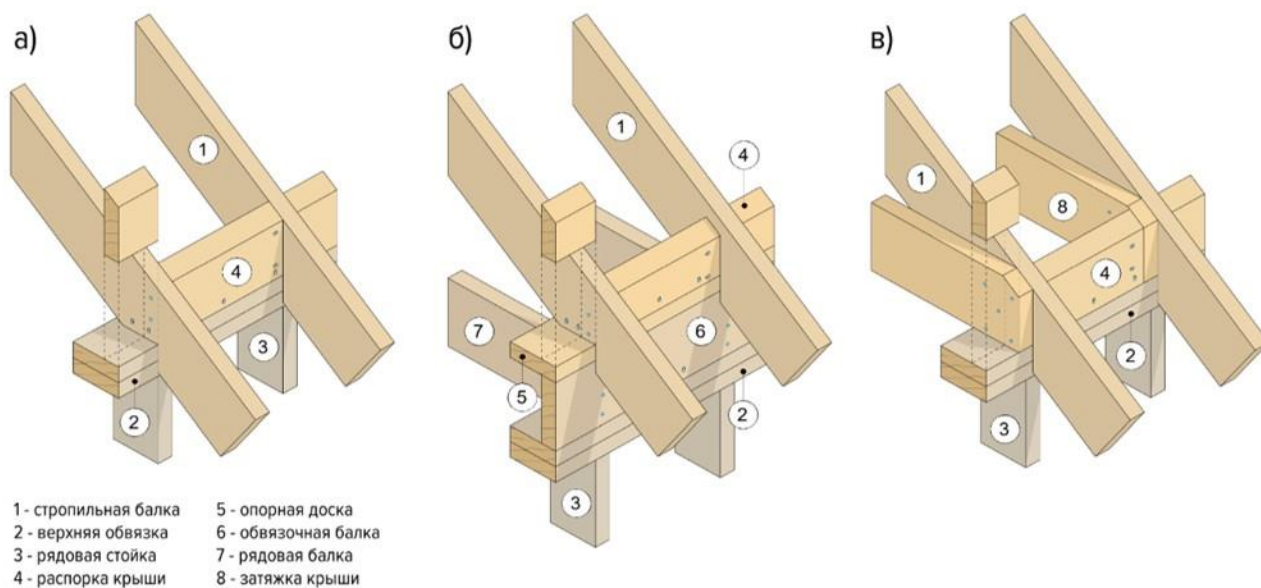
Узел опирания стропильной балки на стену или перекрытие
